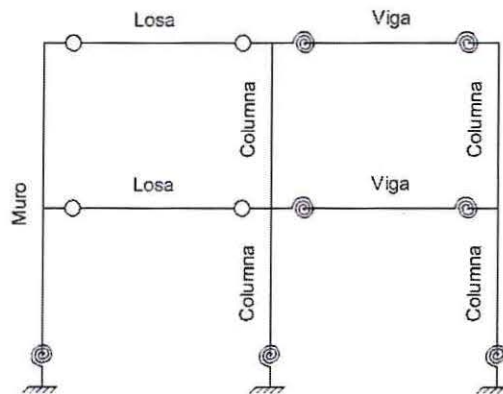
Esquema de resortes en columnas, muros y vigas, de hormigón armado.
